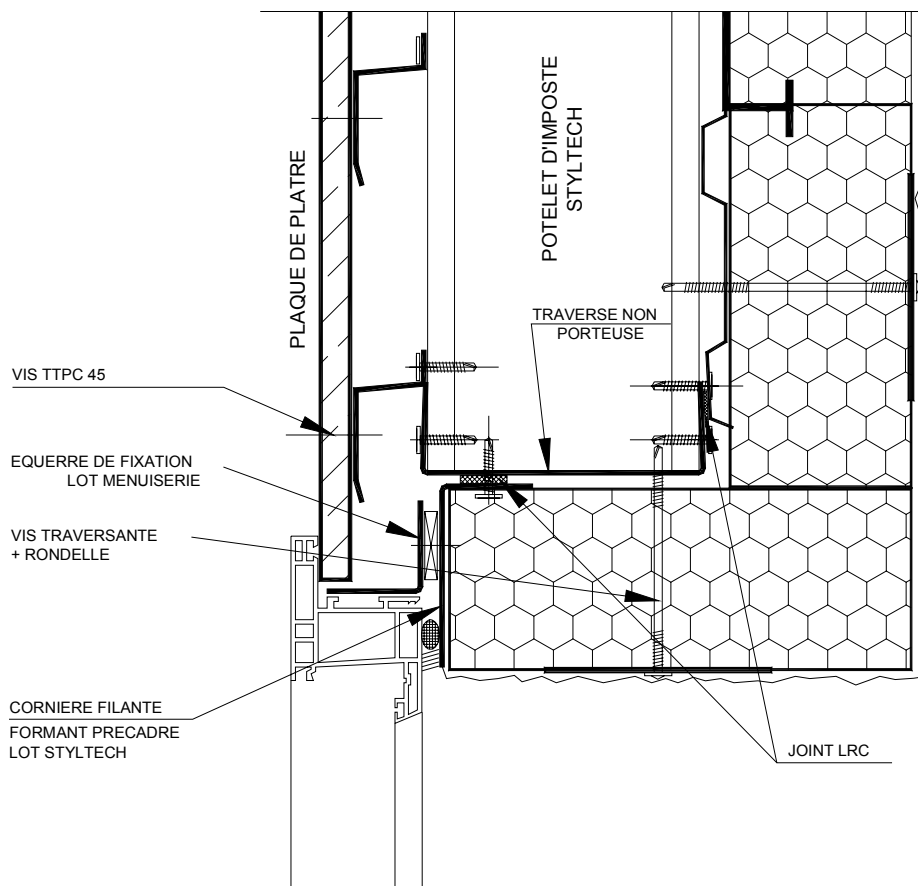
Coupe verticale sur fenêtre – Traverse haute – Menuiserie au nu intérieur
